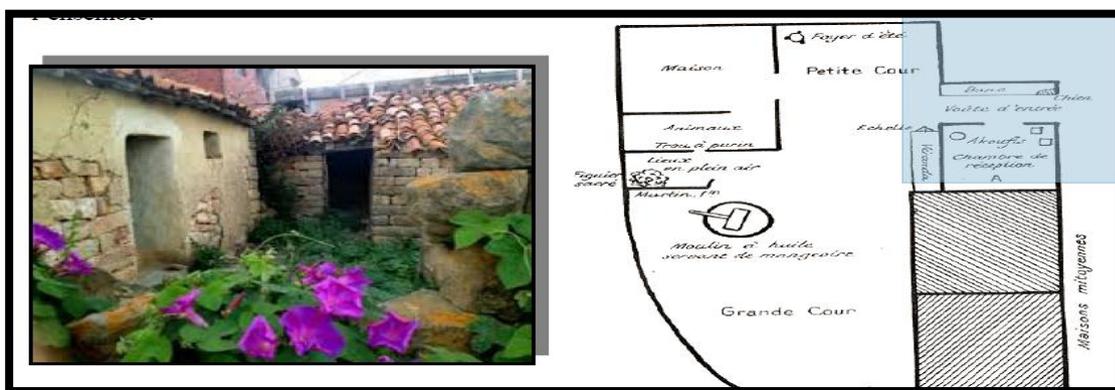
Plan et façade d'habitat Kabyle traditionnel Source : google image
